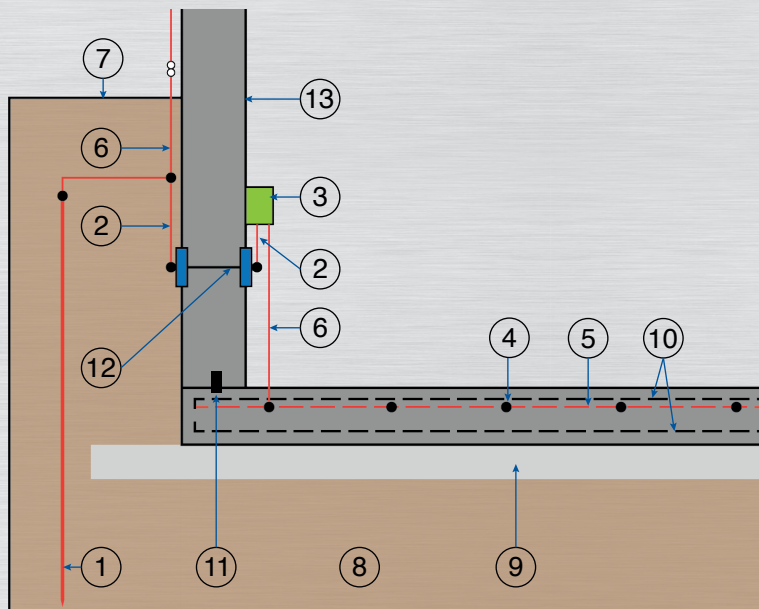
Stab-/Tiefenerder und kombinierte Potentialausgleichsanlage bei wasserundurchlässigem Beton (weiße Wanne) in bewehrtem Fundament
